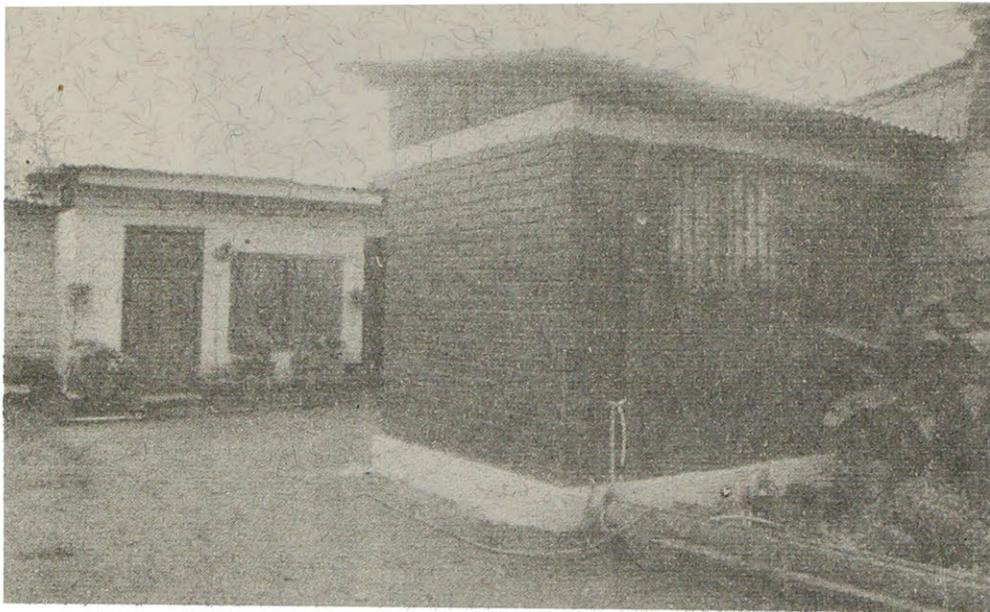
Caseta Sanitaria con sistema constructivo de Albañilería de Ladrillos Reforzada en la Región Metropolitana. Julio 1993.
